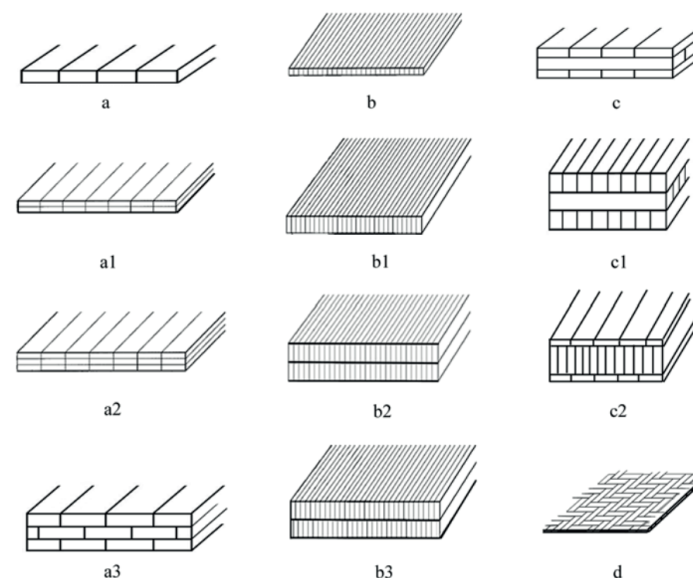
Disposição estrutural das ripas para painéis em BLC
